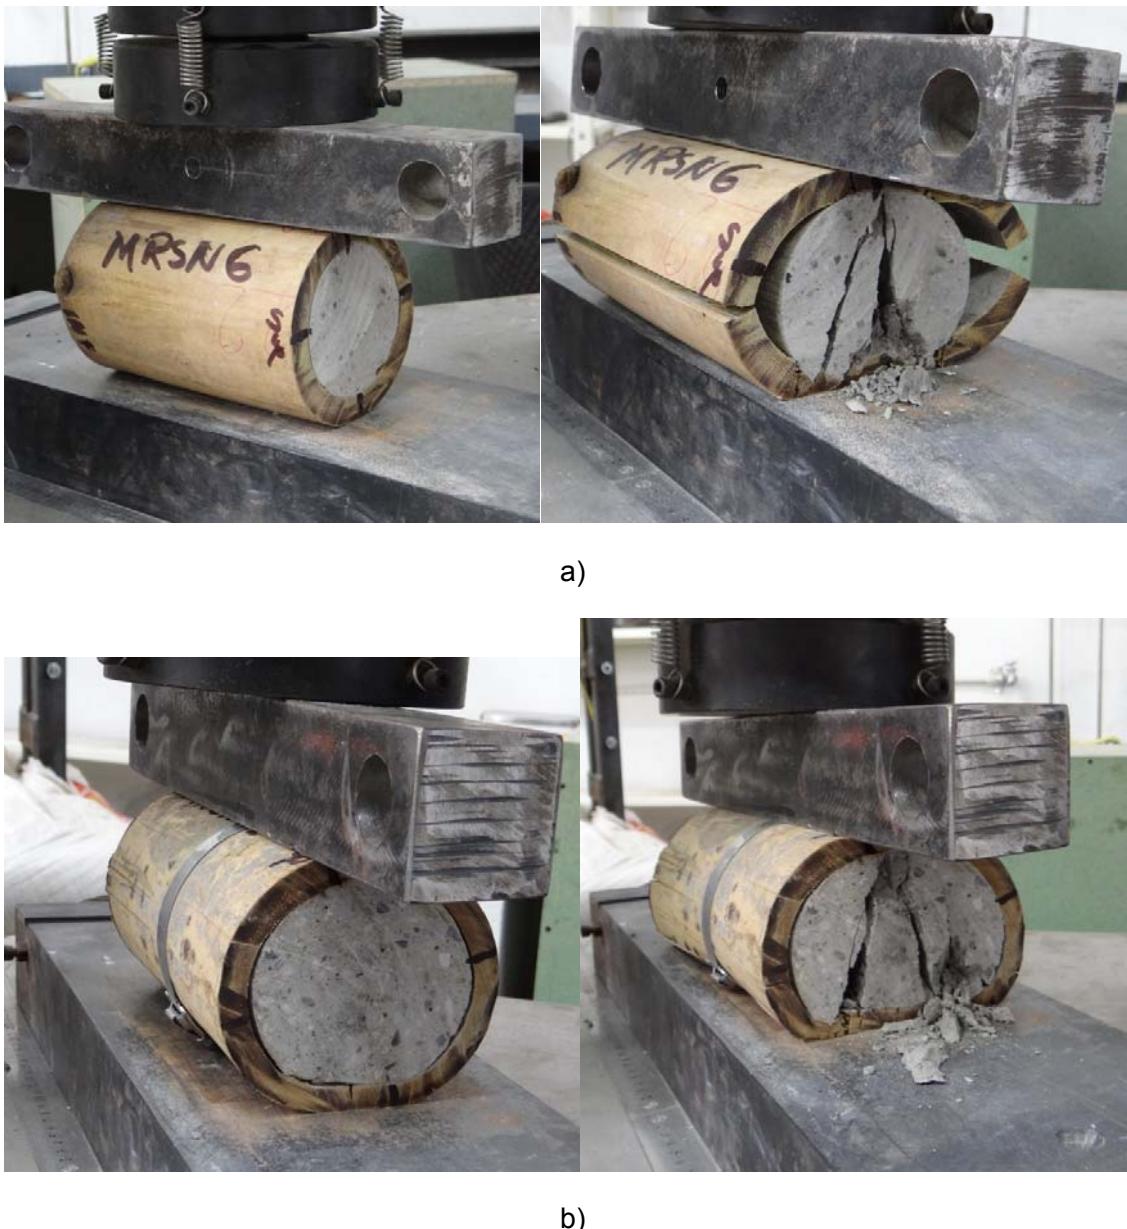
Probetas rellenas de mortero. a) Probeta sin zuncho metálico. b) Probeta con zuncho metálico
